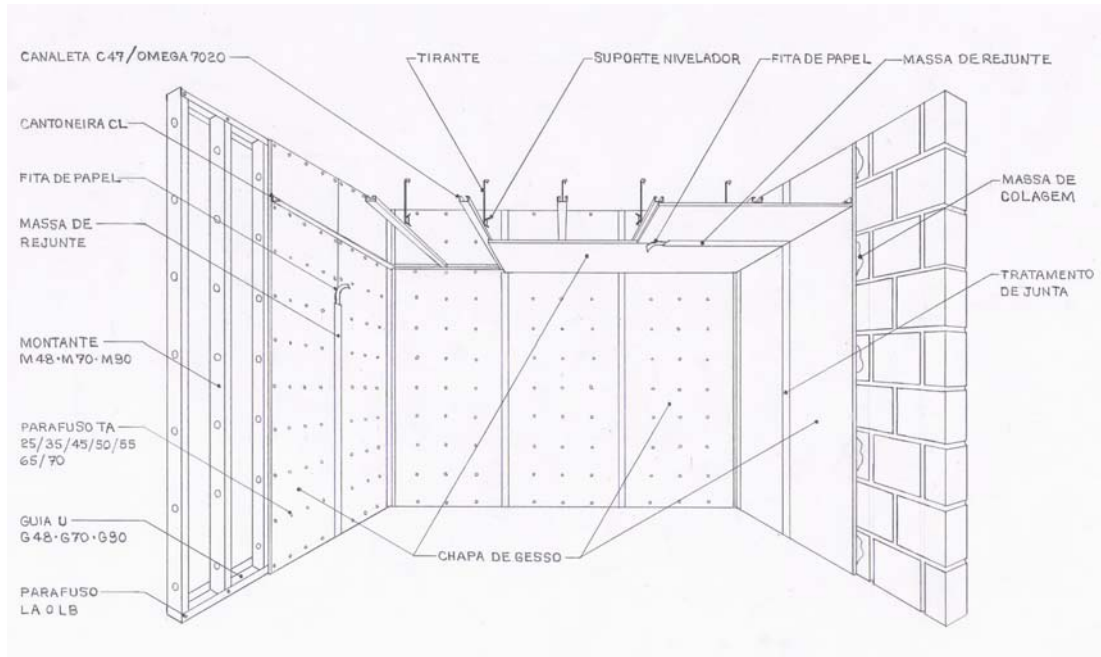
Sistemas Construtivos em Drywall com Chapas de Gesso
